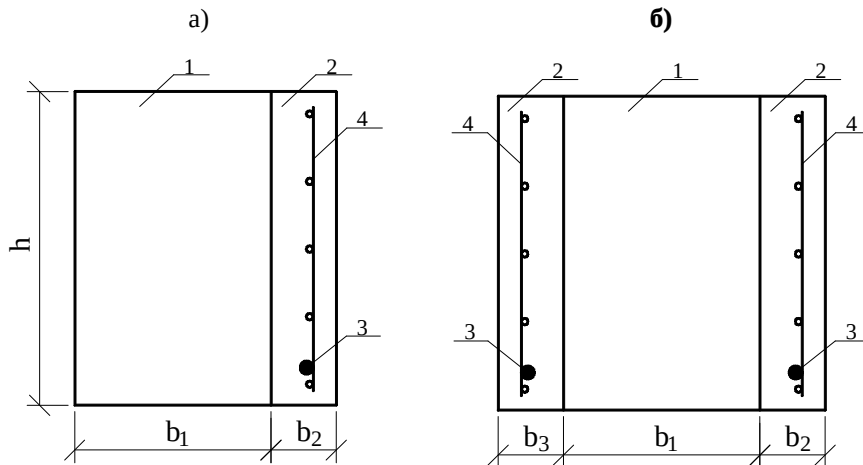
Схеми поперечного перерізу експериментальних балок: а) – з односторонніми пластинами; б) – з двобічними. 1 – газобетонні блоки (цегляна кладка); 2 – залізобетонні бічні пластини; 3 – робоча арматура; 4 – арматурна сітка
